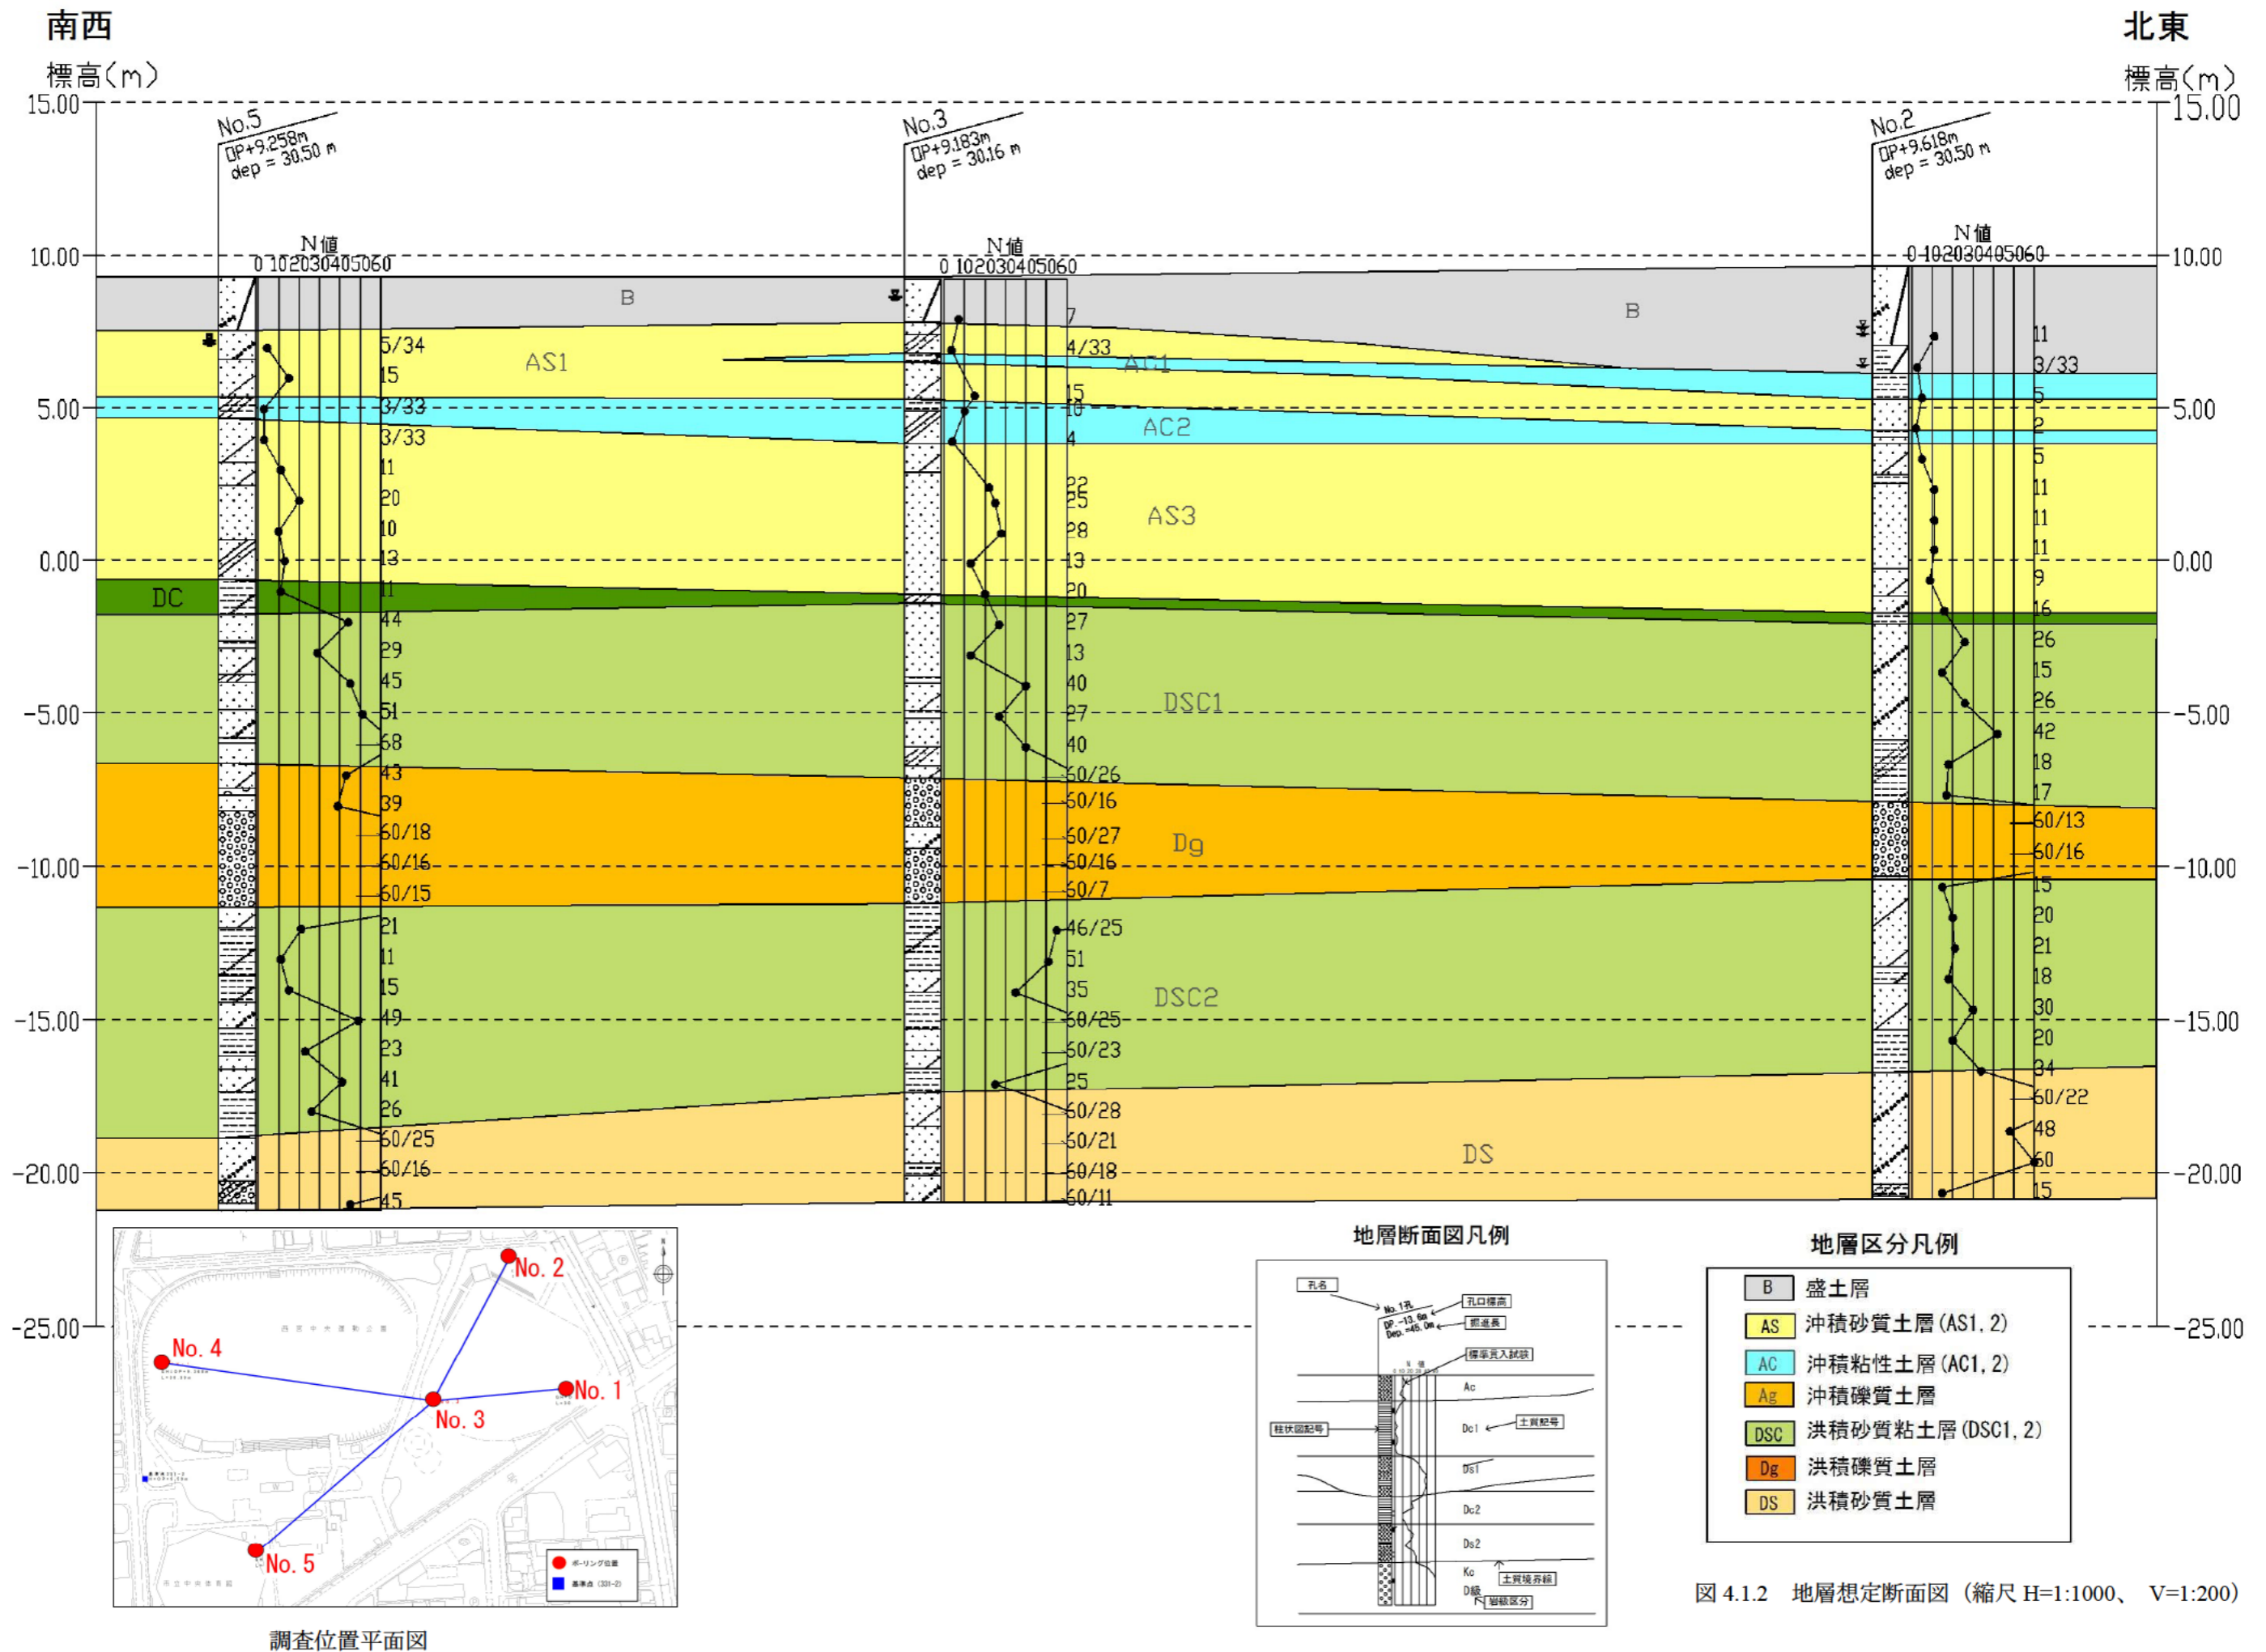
地層想定断面図 (縮尺 H=1:1000、V=1:200)
